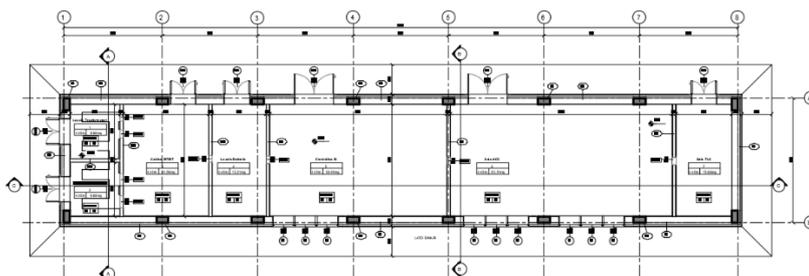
pianta tipologica fabbricati tecnologici FA01 e FA02
